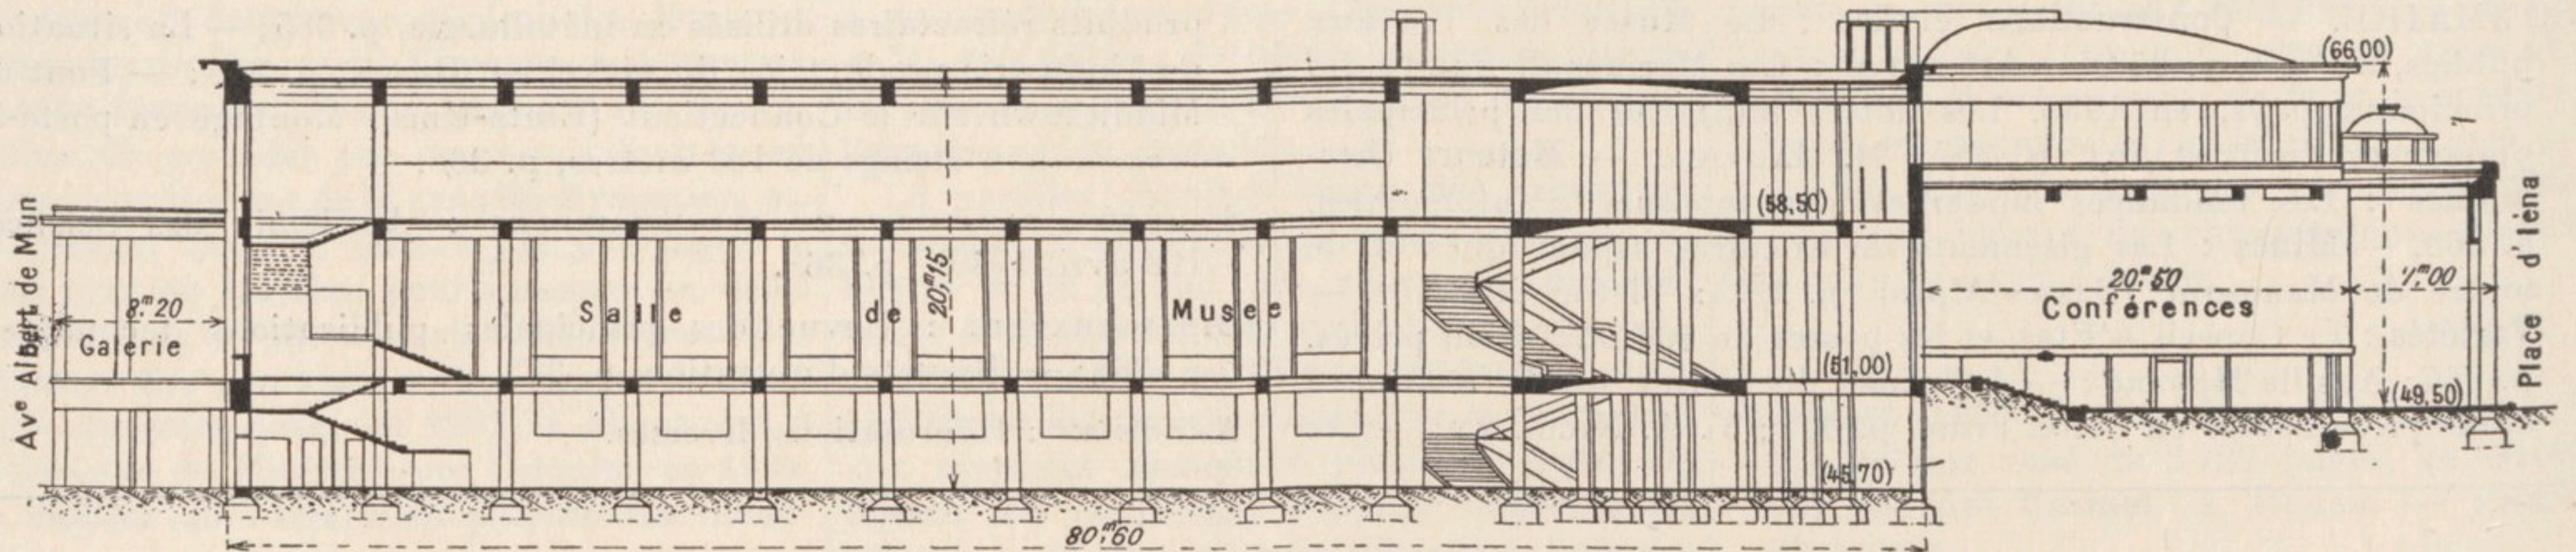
Coupe longitudinale du Musée des Travaux publics, par les salles du musée et la salle de conférences.
